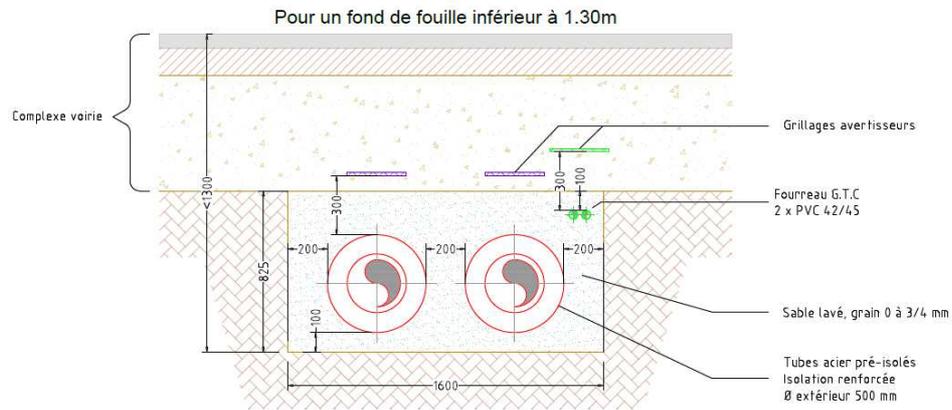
Coupe type - exemple 1 (profondeur < 1.3 m)
